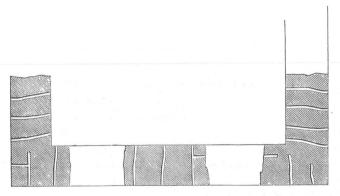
Huellas de la viguería del andamiaje en un muro romano (templo de Jano en Autun)
